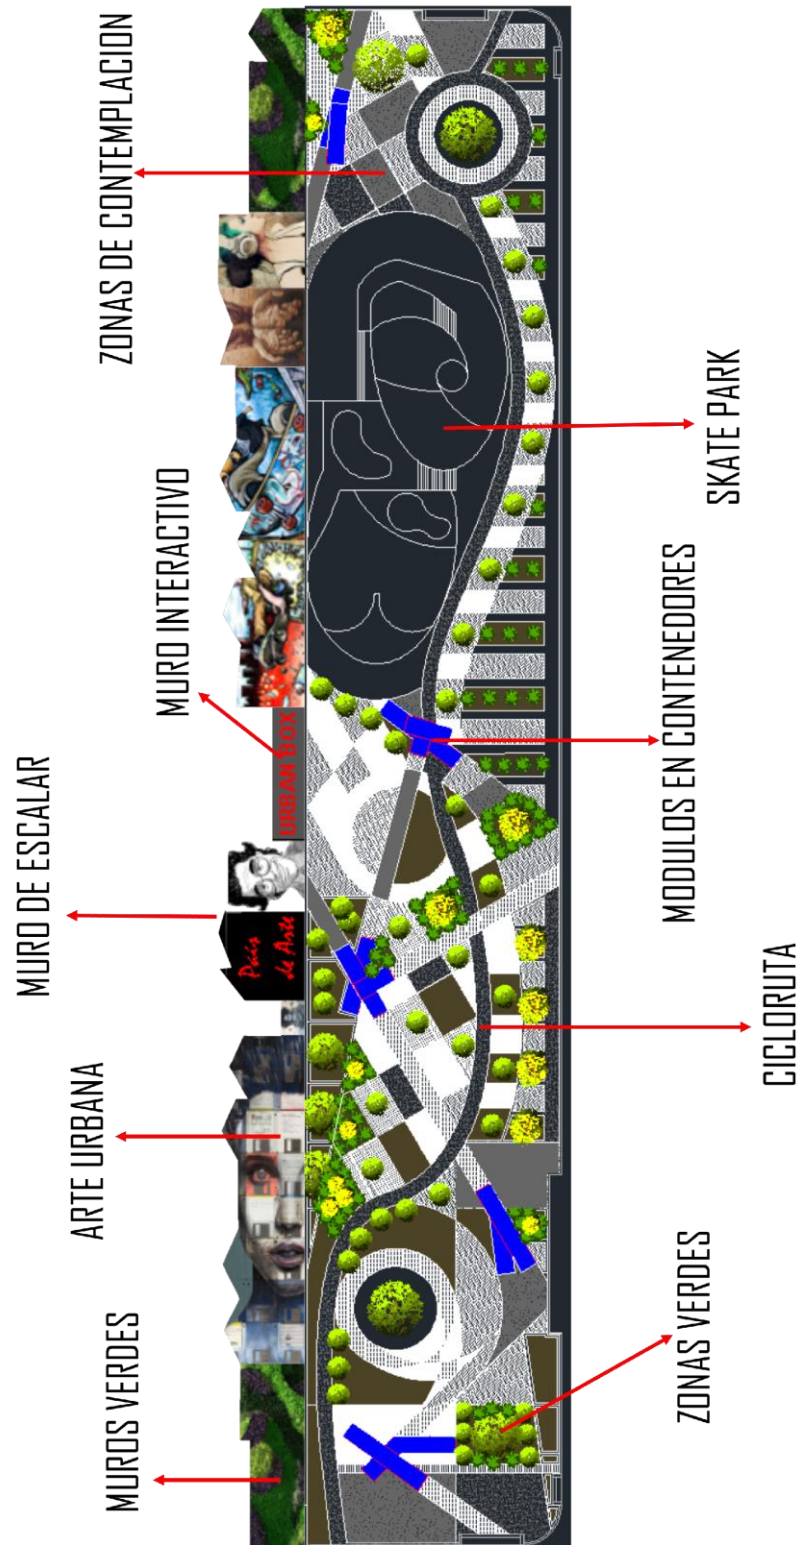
“Imagen de la planta del proyecto, junto con la intervención de la culata.”
